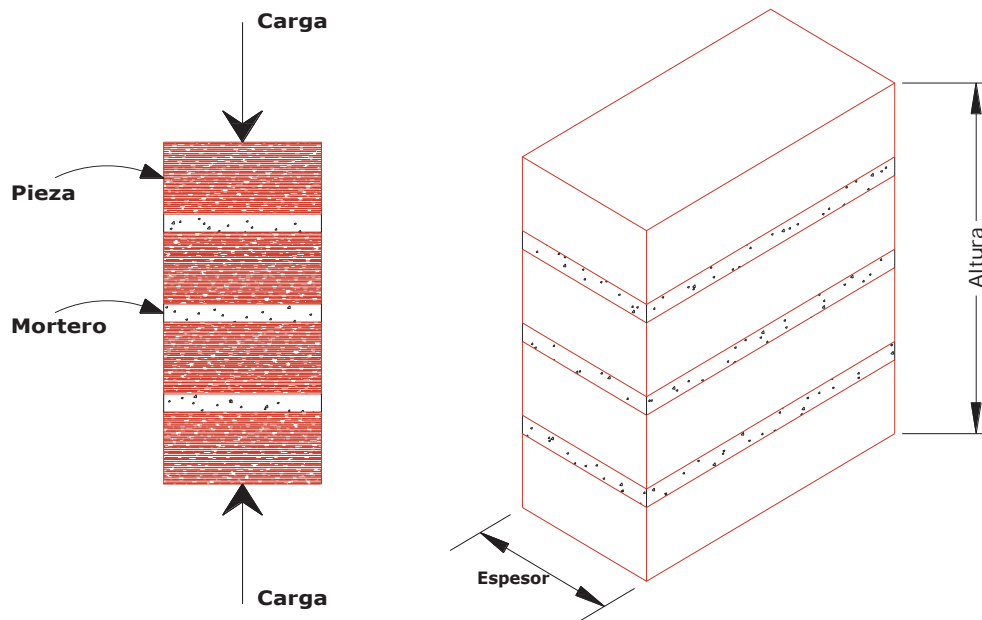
Consideraciones para la Prueba de Compresión Simple en Mamposterías
